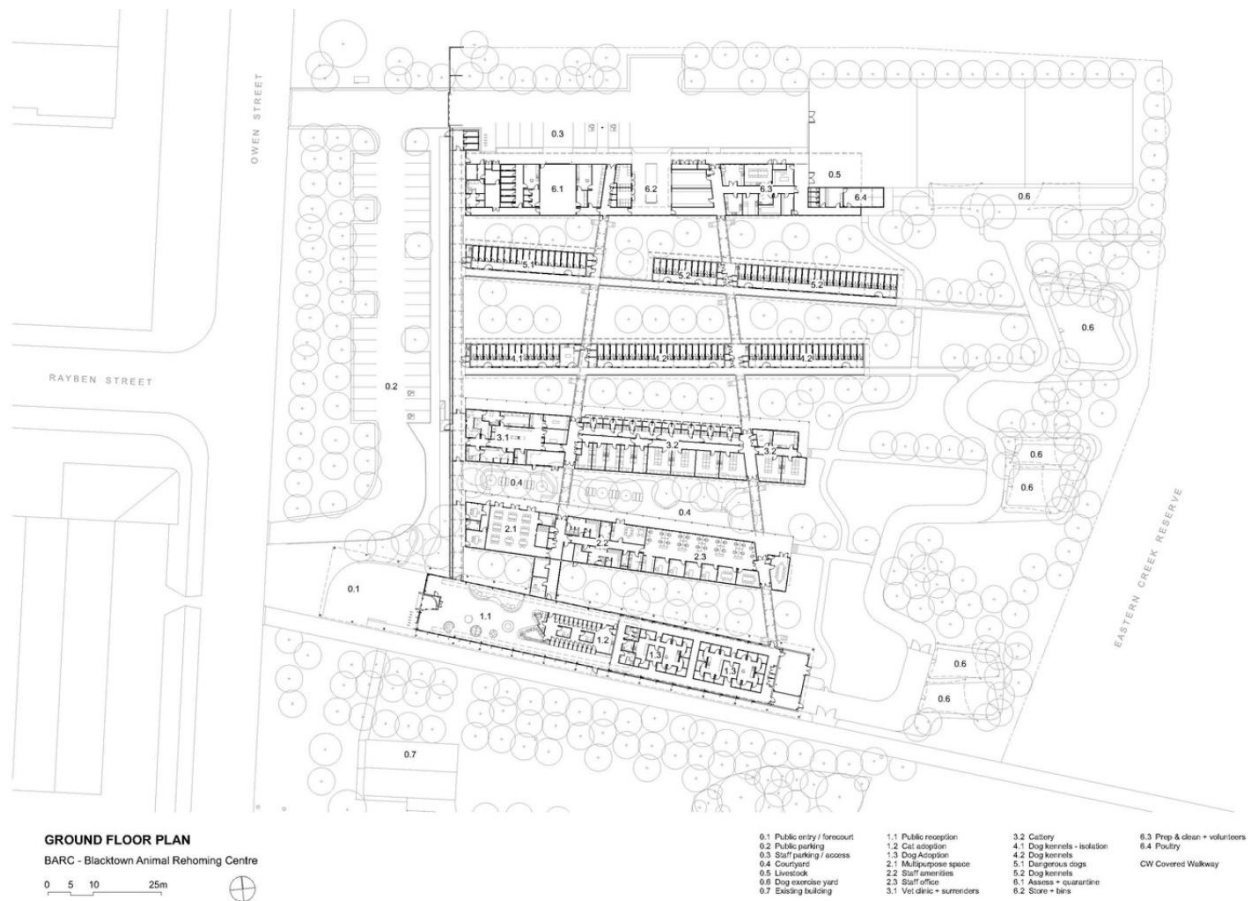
Центр прилаштування тварин у Блектауні (BARC) / Sam Crawford Architects. План першого поверху з генеральним планом ділянки[2].
